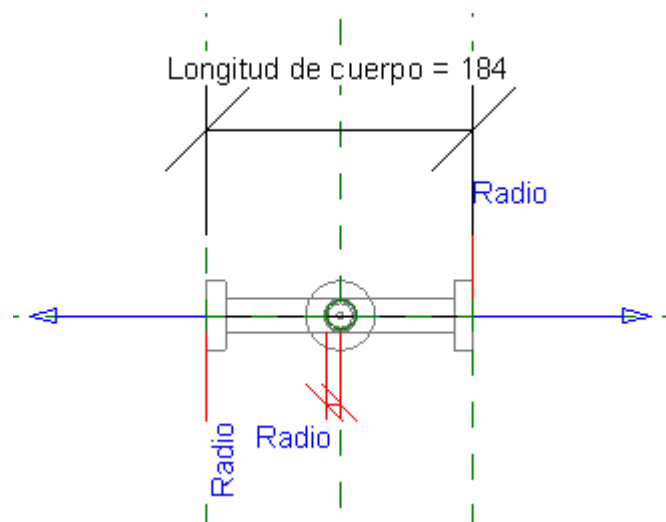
Planta válvula de 3 vías biblioteca Revit
